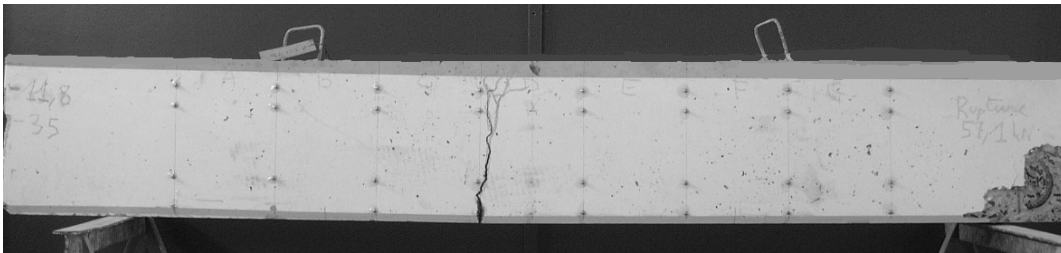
Faciès de fissuration de la poutre ADHTO.
